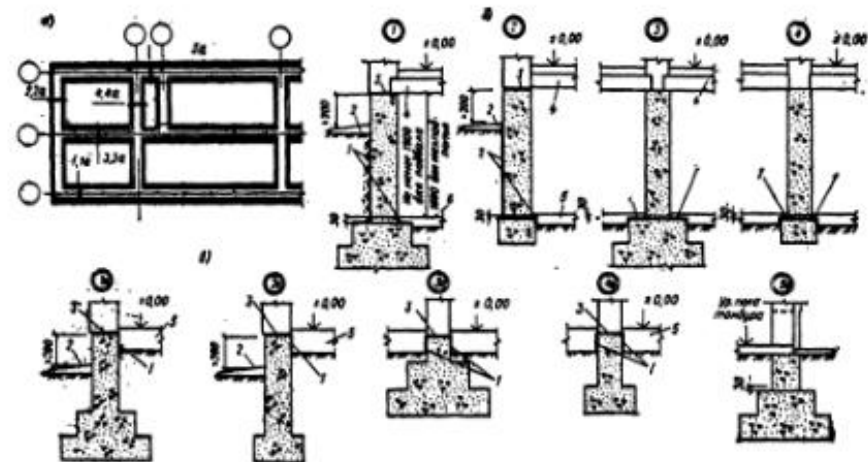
Монолитные ленточные фундаменты: а - схема плана фундамента с маркировкой сечений; б - детали сечений фундаментов под стены зданий с подвалами и техническими подпольями; в - то же под стены зданий без подвалов и технических подполий; 1 - окраска горячим битумом за два раза; 2 - отмостка; 3 - два слоя толя или гидроизоляция на битумной мастике; 4 - цокольное перекрытие; 5 - конструкция пола по грунту
